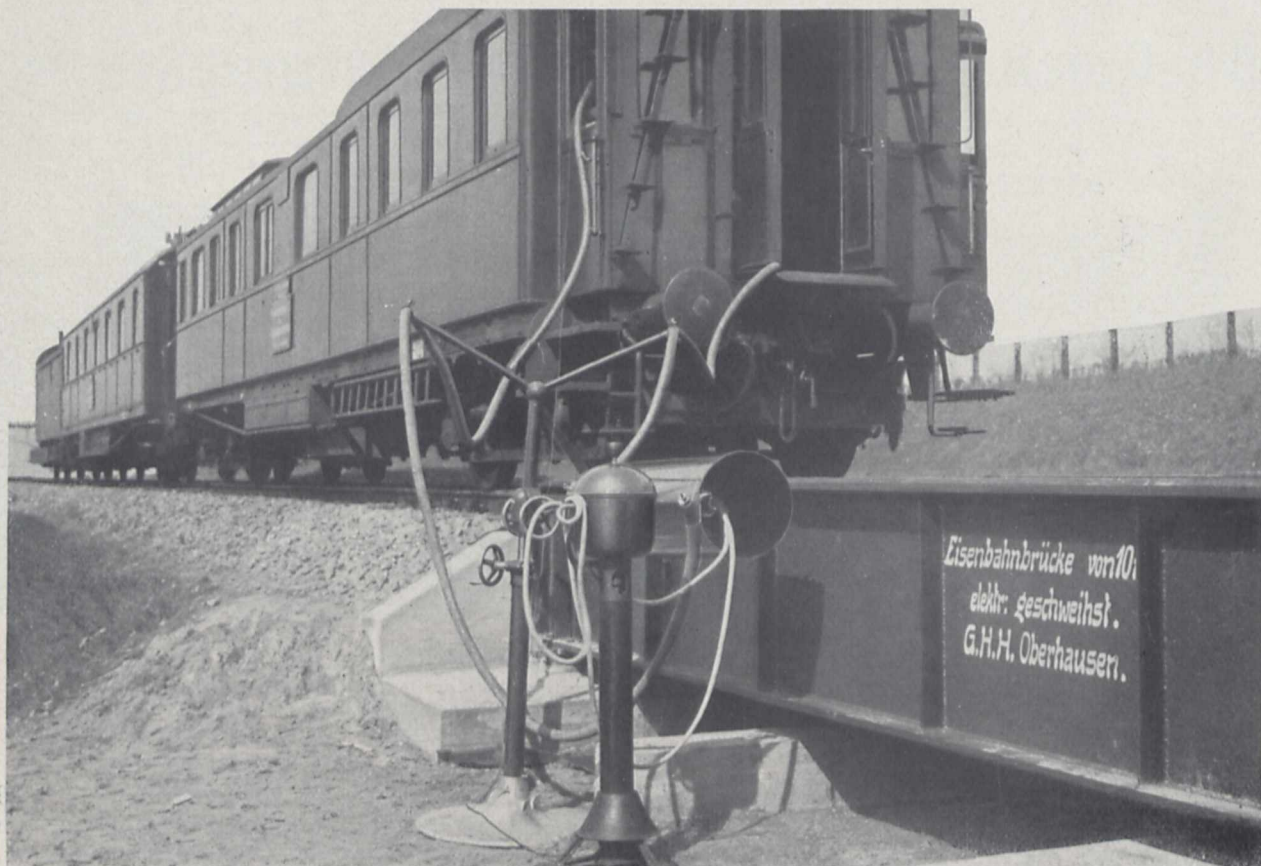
Röntgenuntersuchung an einer geschweißten Brücke mit dem Ueberland-Röntgenprüfzug auf freier Strecke
